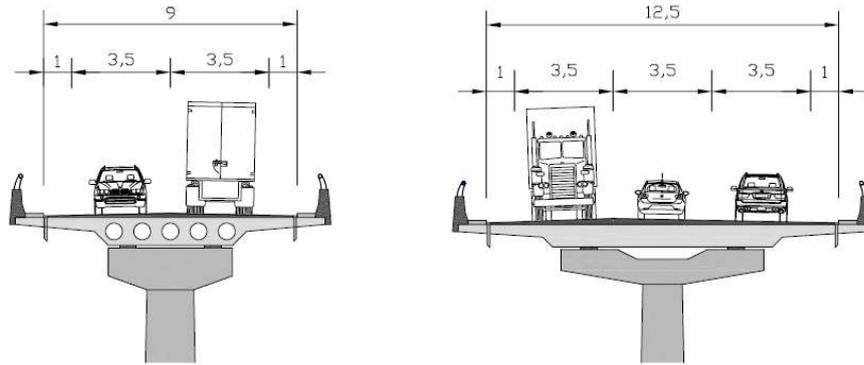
SECCIONES EN OBRAS DE PASO TIPO 1+1 Y 2+1
